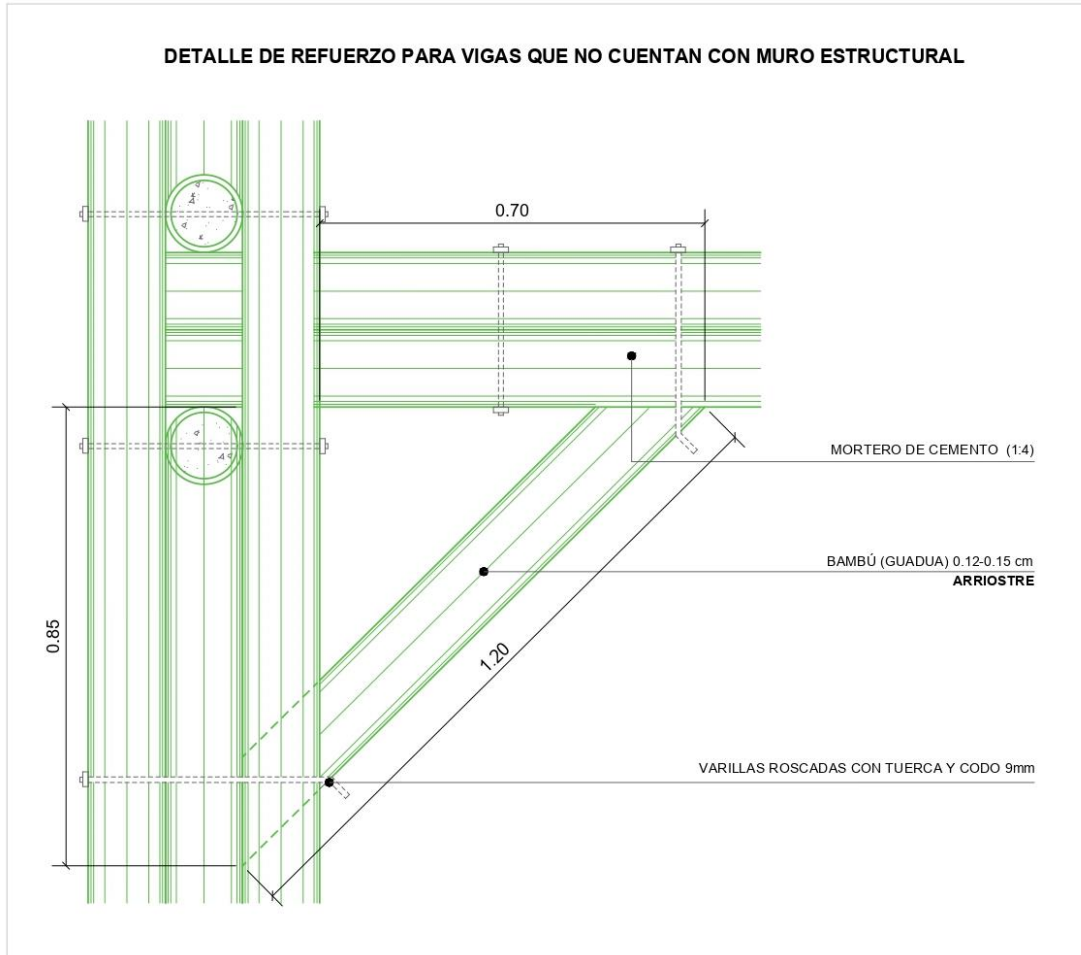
Detalle constructivo de refuerzo para viga compuesta. Fuente: El autor
